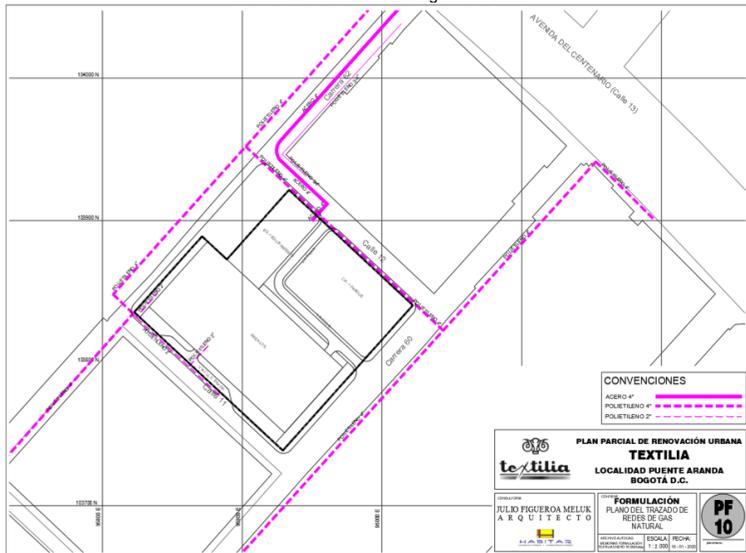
PF10. Trazado de Redes de Gas Natural
